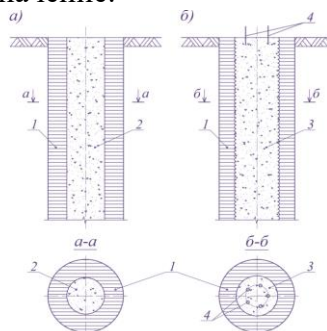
Схема устройства грунтобетонной сваи (ГБС).
